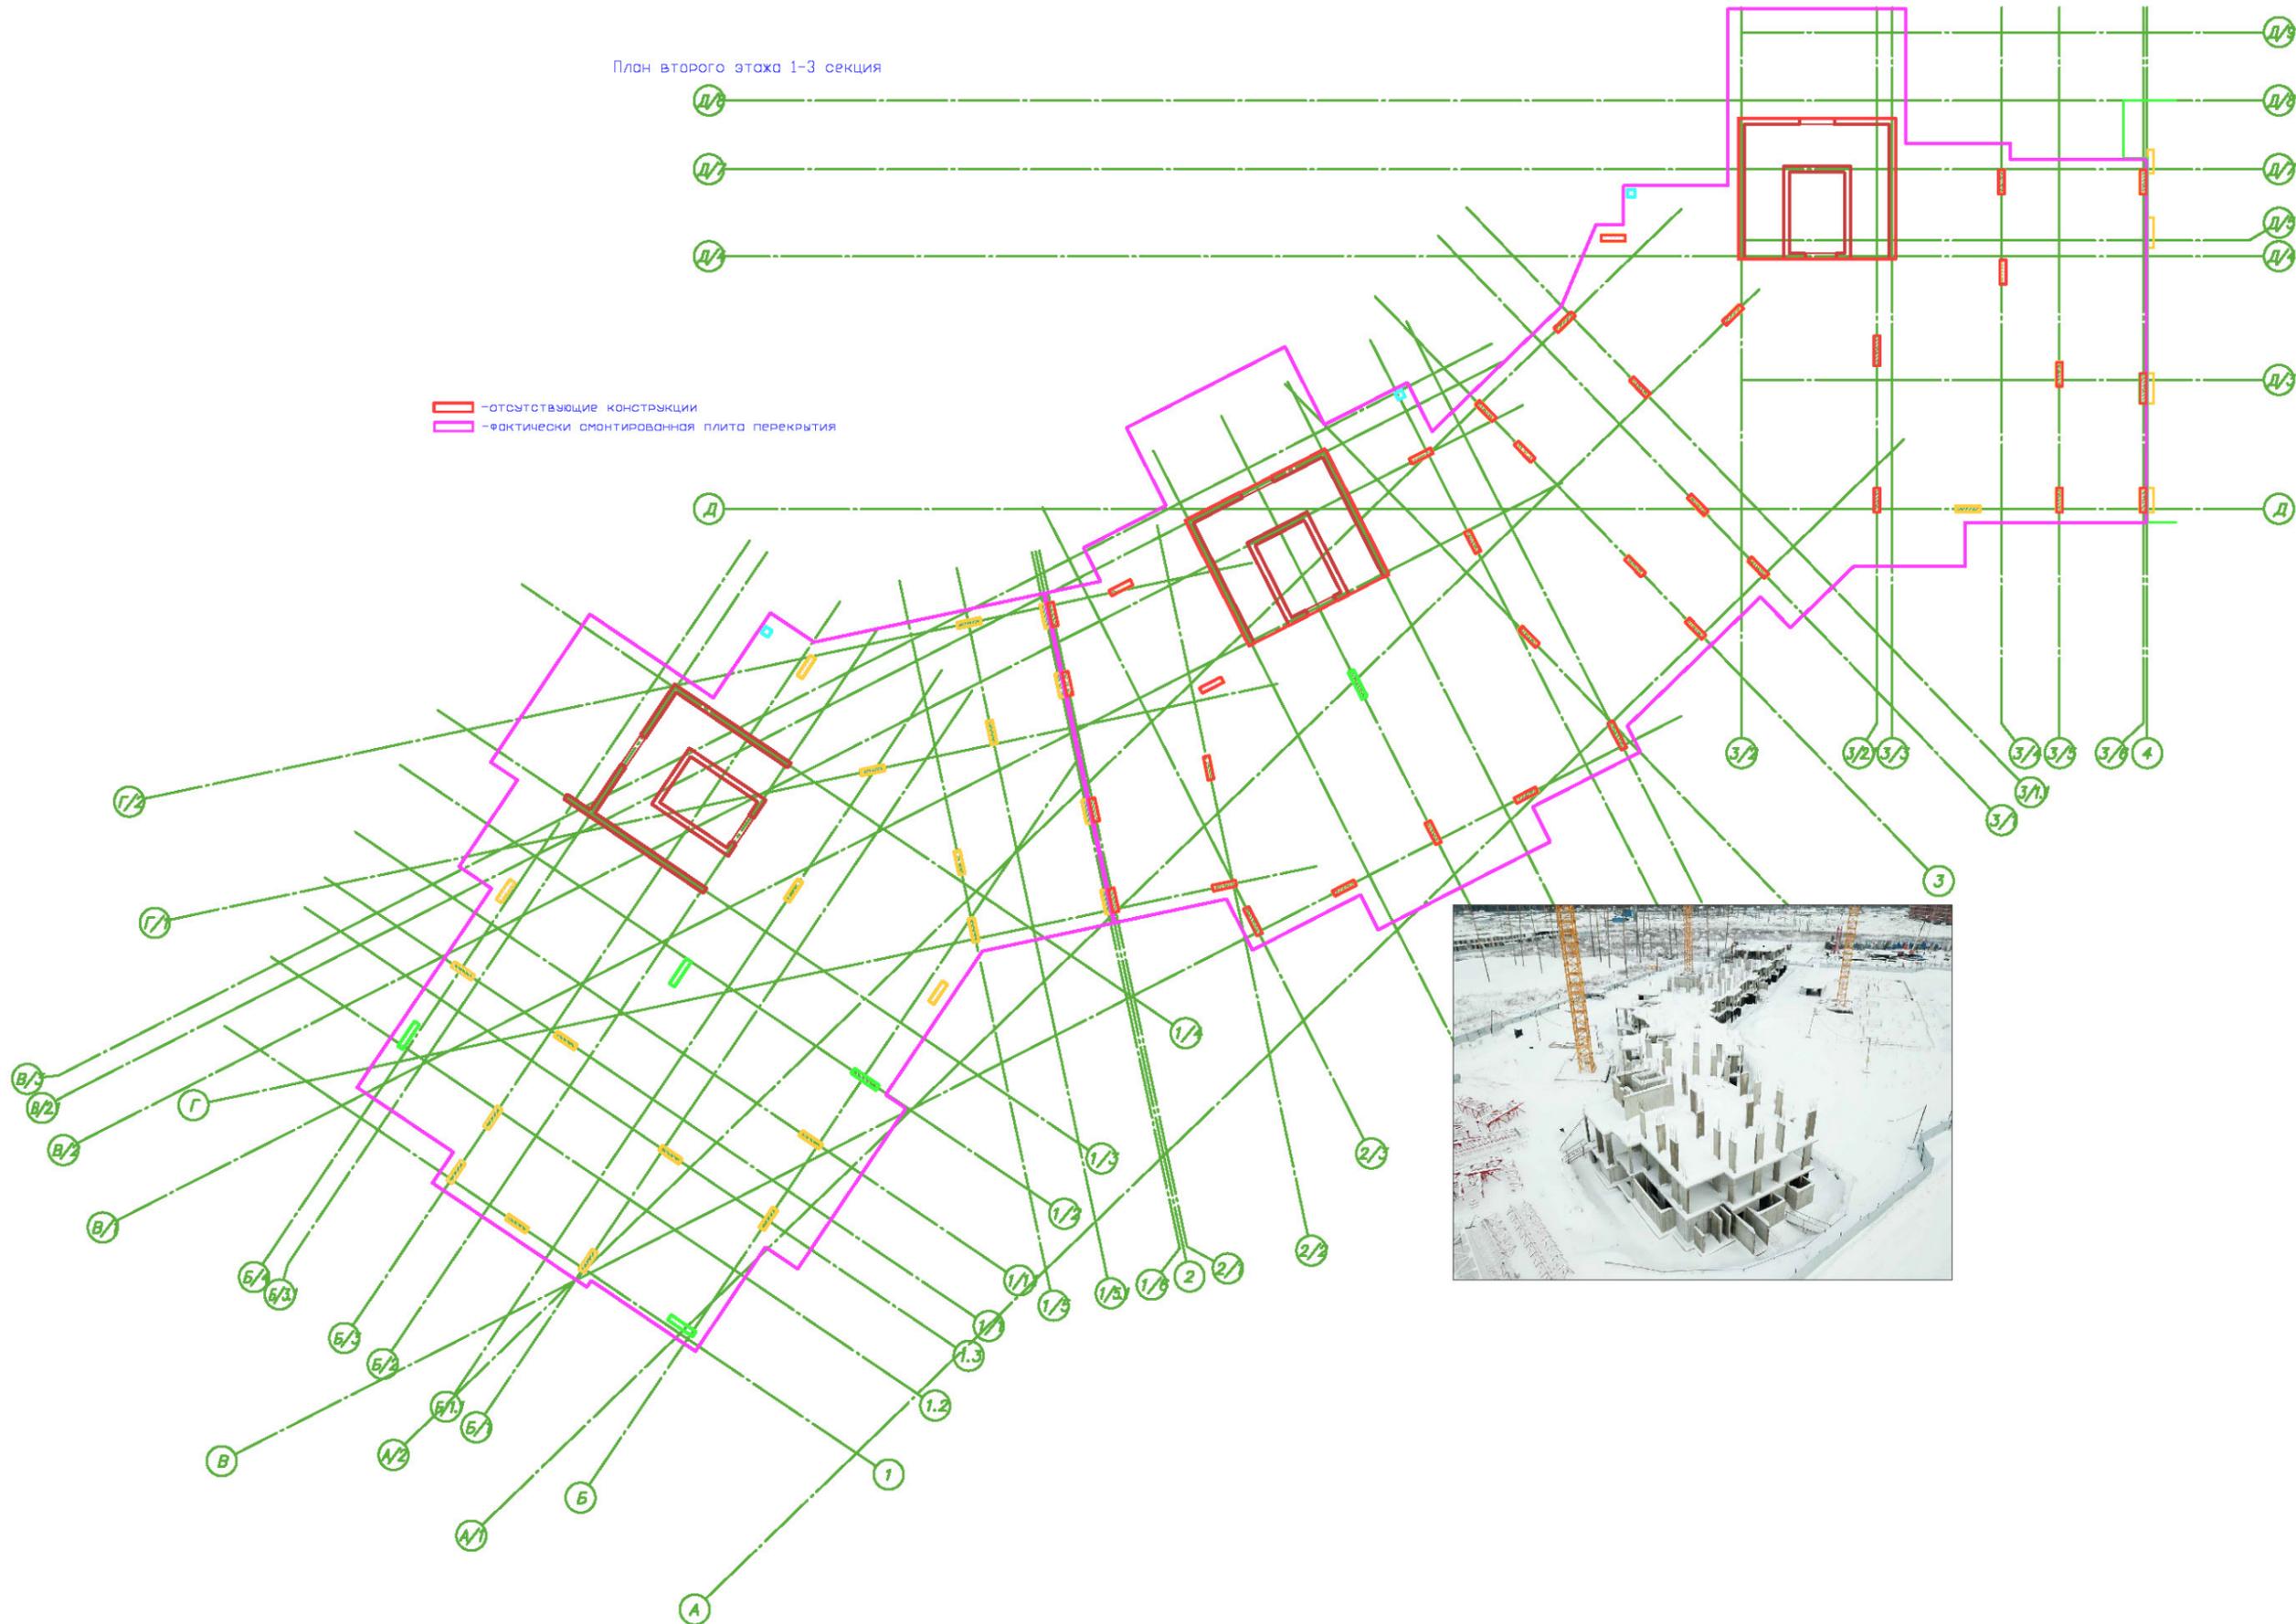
План фактически смонтированных конструкций 2-го этажа секций №1-3
